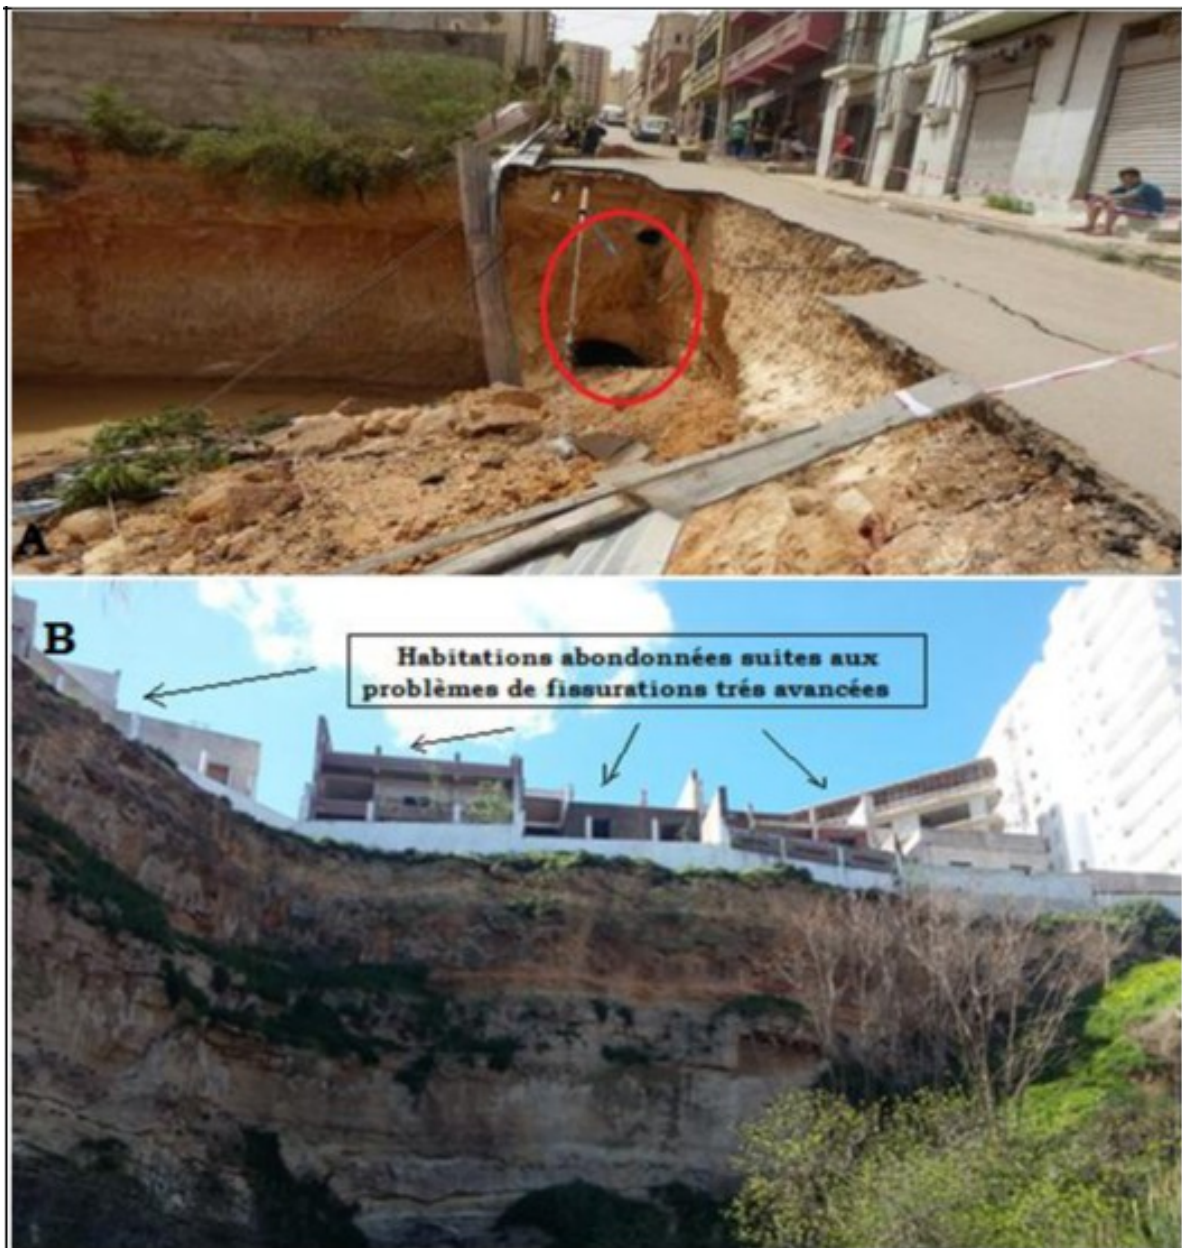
Affaissement de chaussée (A) et fissurations d'habitations (B)
